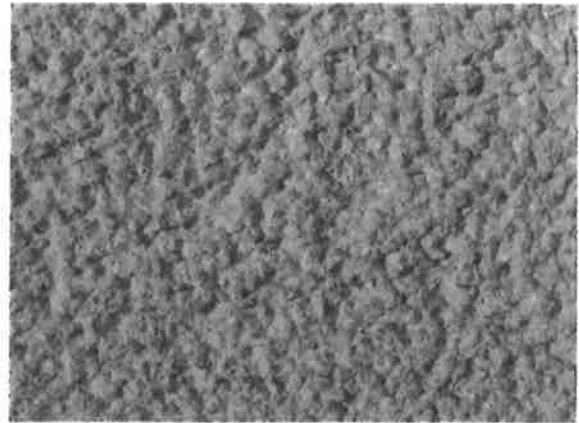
Gespitzte Betonoberfläche, weißer Zement
